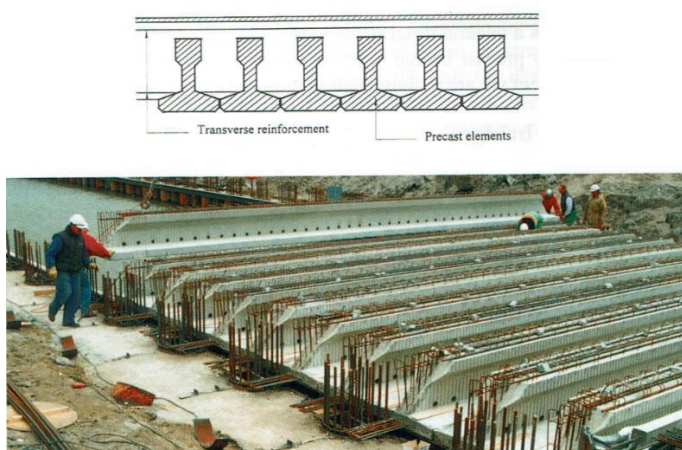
Ponte pré-fabricada de laje maciça antes da betonagem, Spanbeton BV, Países baixos. (FIB, 2004)
